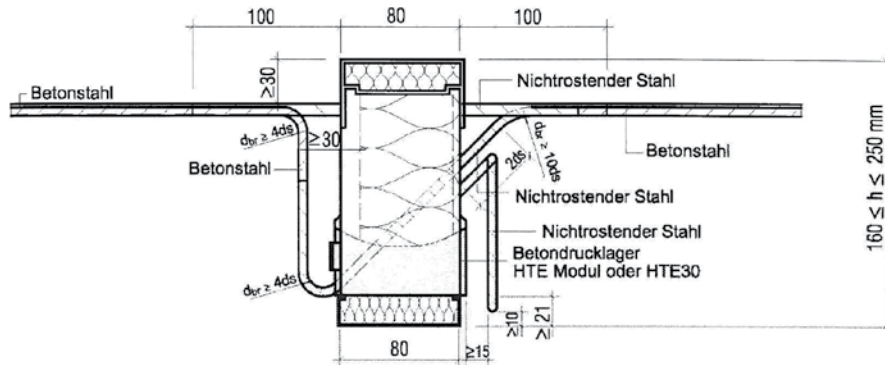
Schöck Isokorb Typ K¹⁾ mit integrierter Aufhängebewehrung gem. Abschn. 3.3.1 und Sonderbügel
